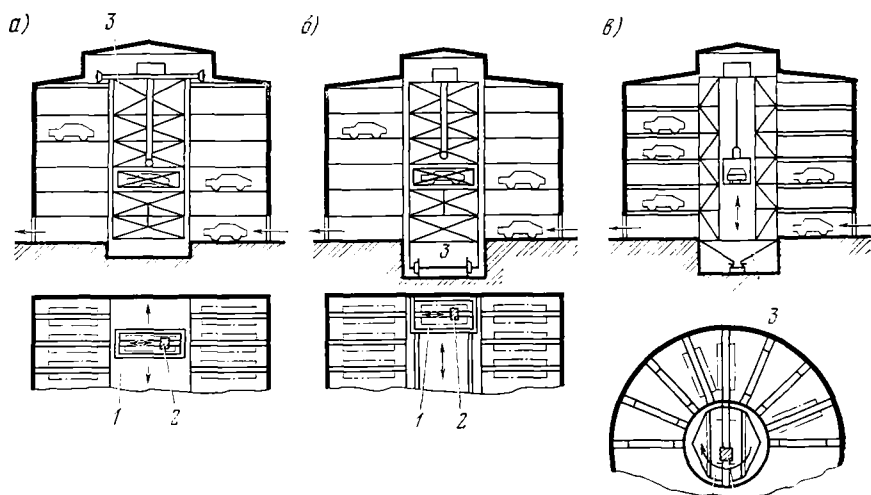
Схемы механизированных стоянок с подвижными шахтами лифтов: а — с подвижной шахтой; б — с шахтой на опорных роликах; в — с поворотной шахтой лифта; 1 — кабина лифта; 2 — буксирующая тележка; 3 — шахта лифта
